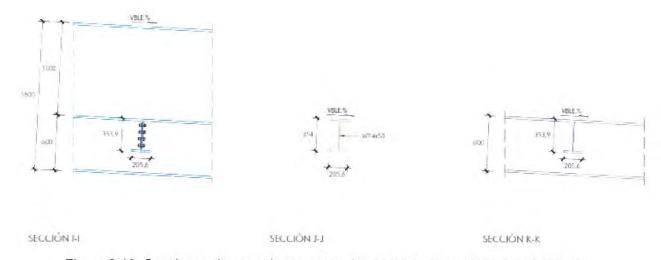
Secciones de conexiones entre elementos trasversales y longitudinales.
